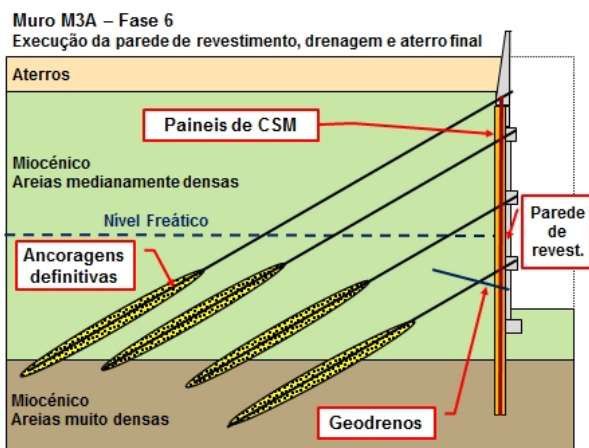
Fase 6 do faseamento construtivo do Muro M3A
